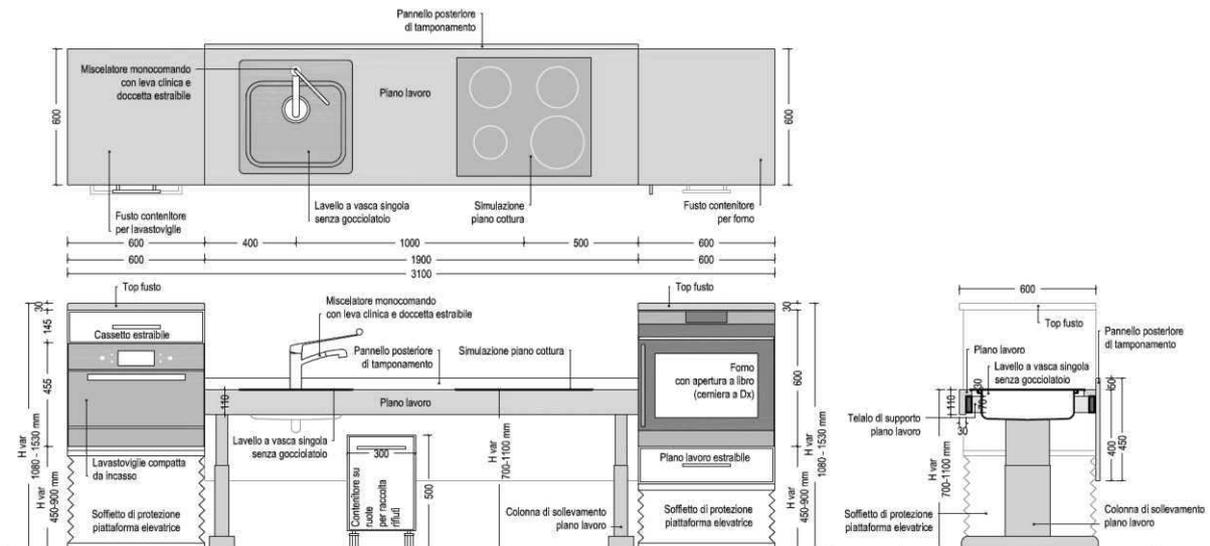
Pianta, prospetto frontale e sezione Blocco Preparazione
